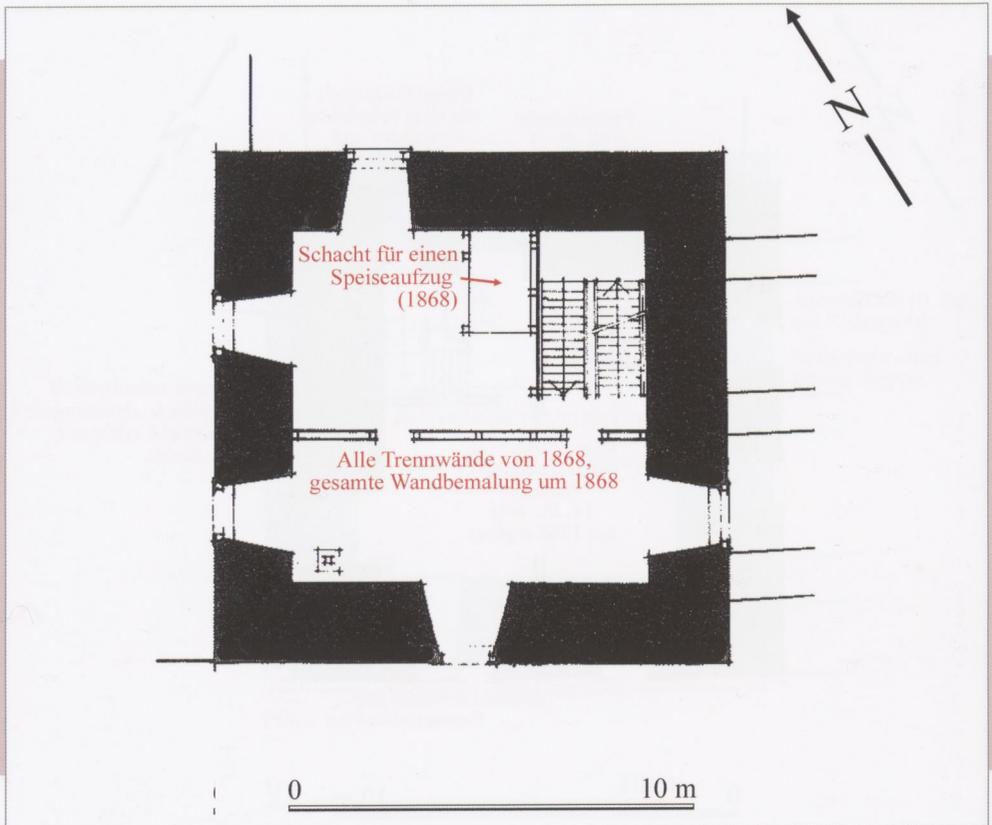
Maienfeld, der Wohnturm, Grundriss des 6. Geschosses mit Hinweisen auf Befunde in rot (Th. BILLER, Grundlage wie Abb. 5).
